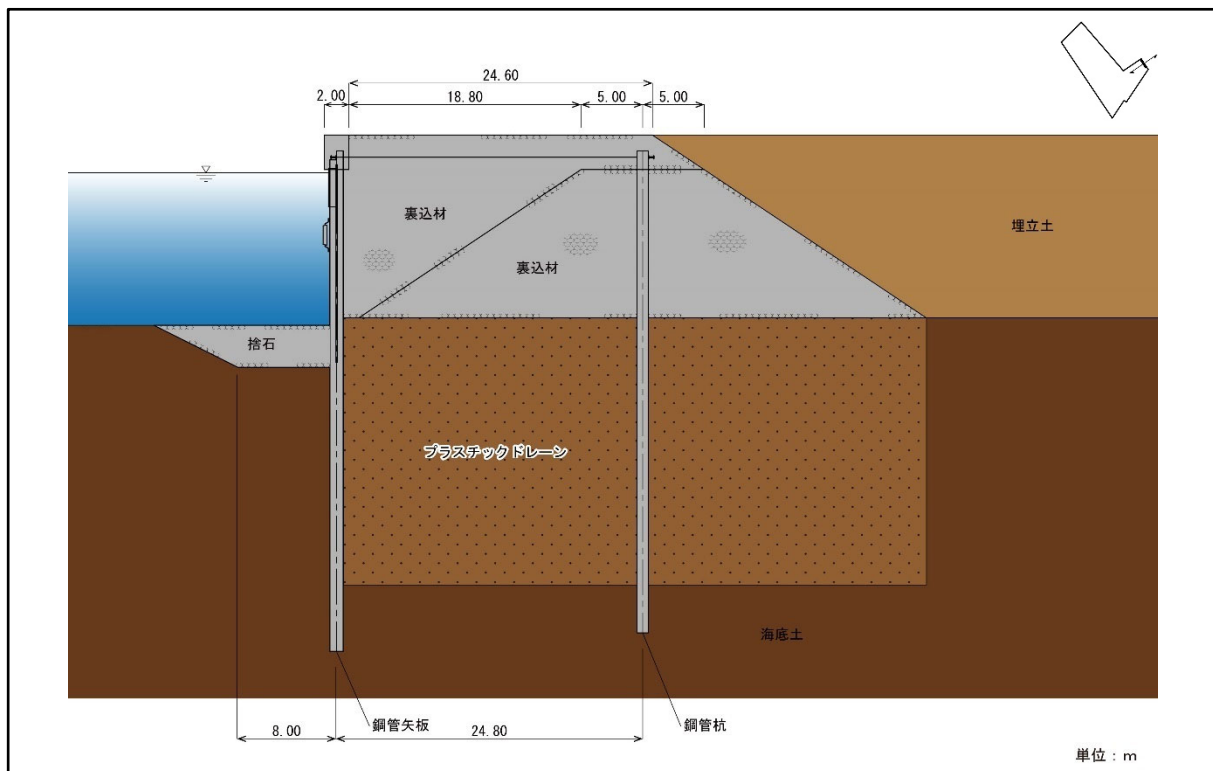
(1) 護岸① (1 工区) の標準断面図
